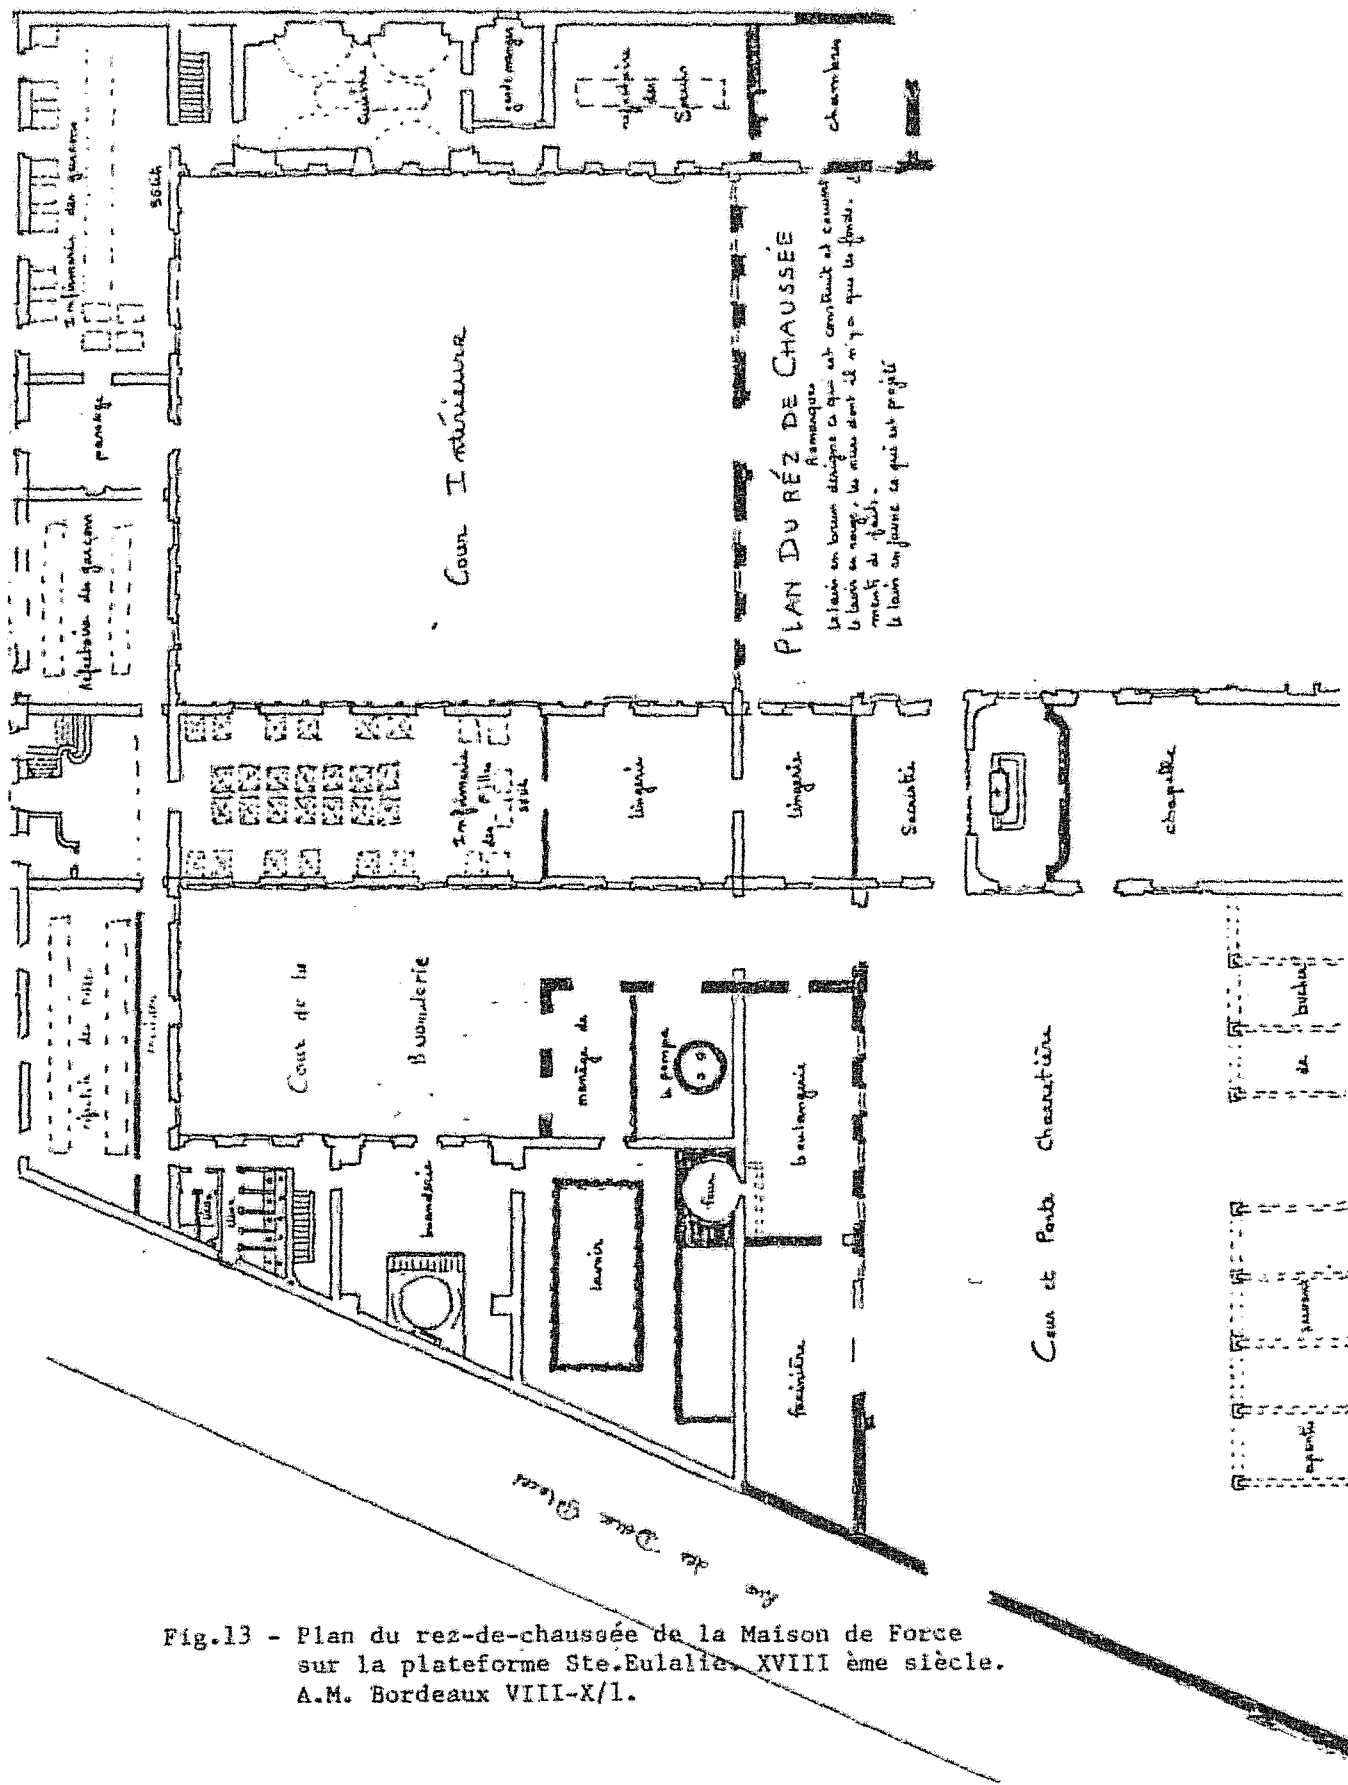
Plan du rez-de-chaussée de la Maison de Force sur la plateforme Ste.Eulalie. XVIII ème siècle. A.M. Bordeaux VIII-X/1.
